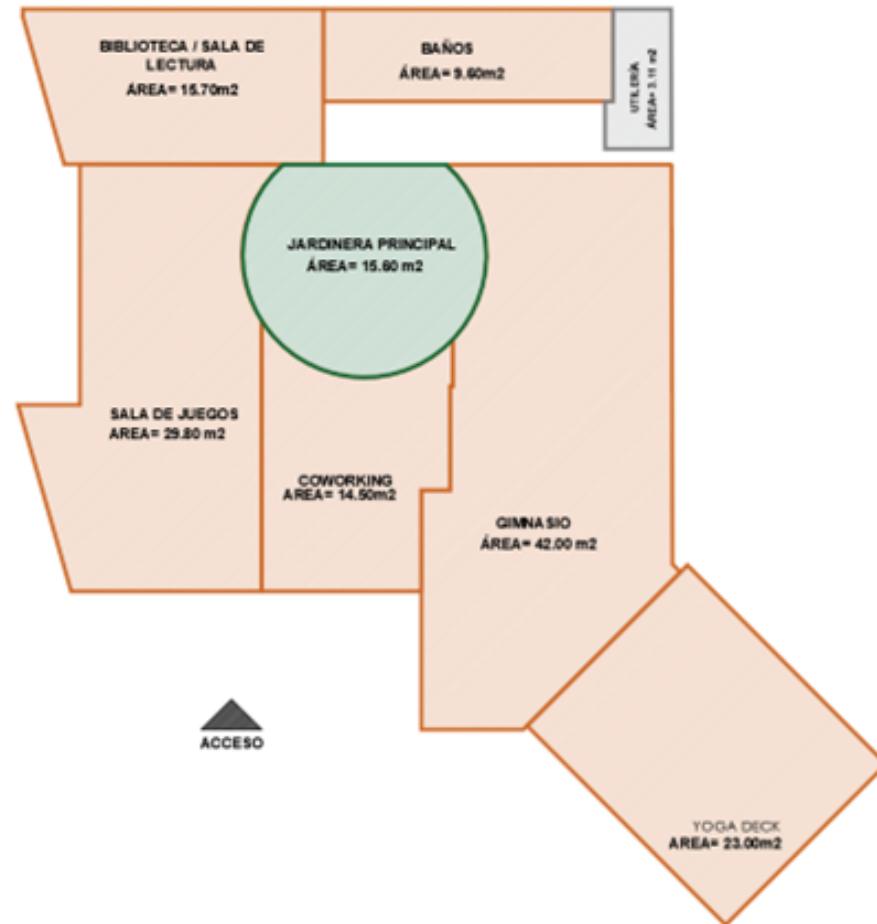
Plano de zonificación: Estefania Sánchez.
